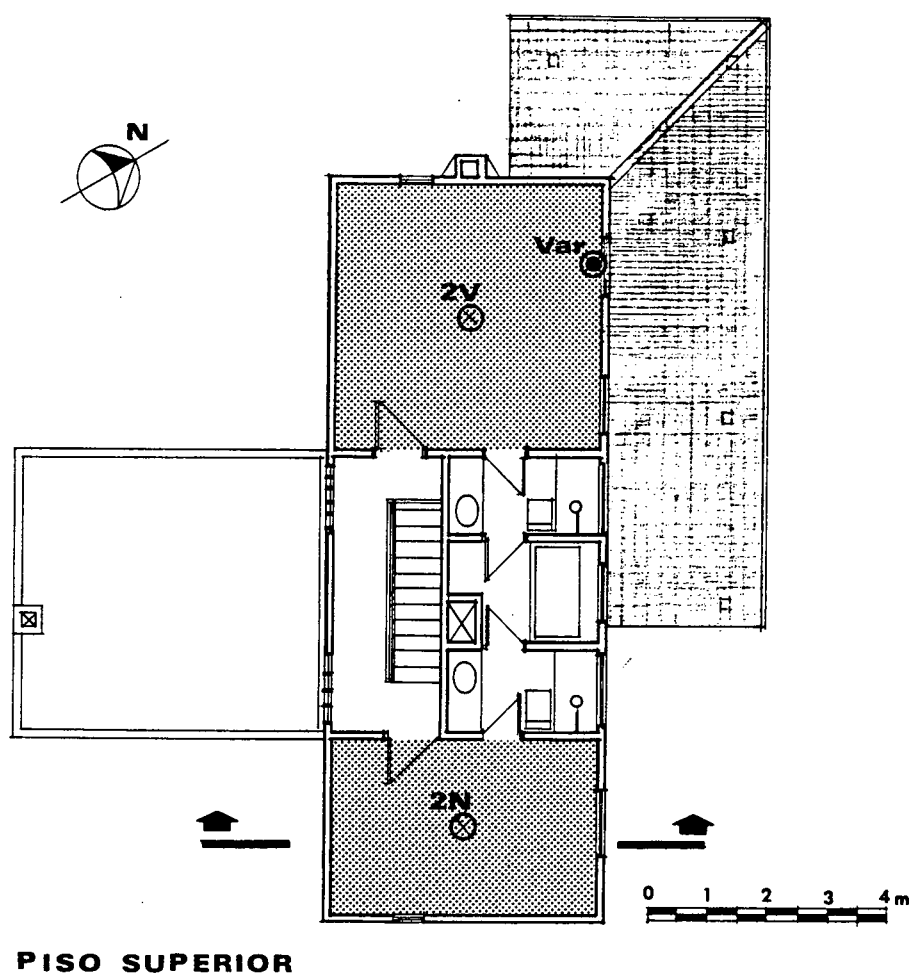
Planta do pavimento superior Casa nº2 (Campeche)
